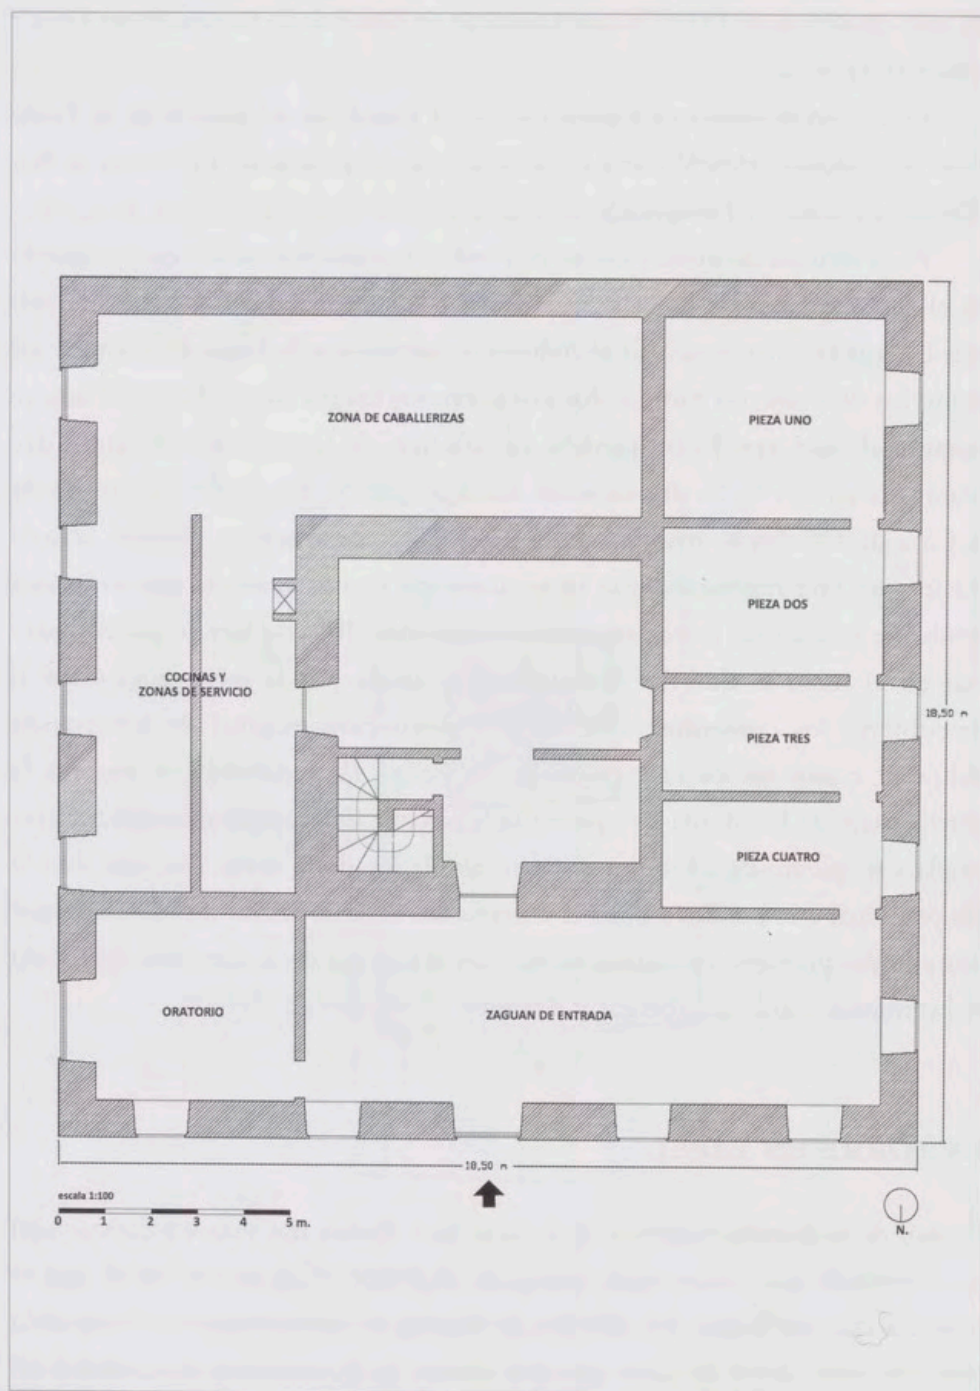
Planta baja de la torre de la Parada, dibujo de los autores.
